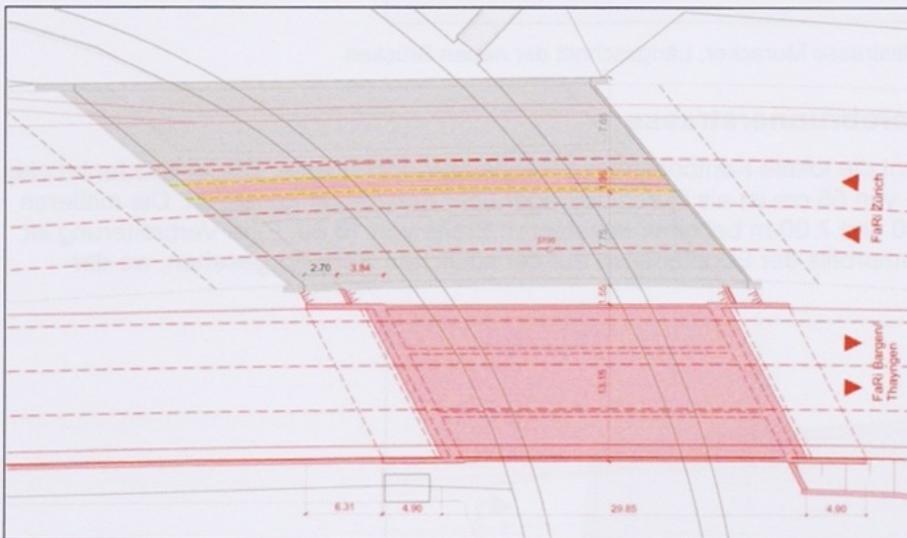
Unterführung Gemeindestrasse Muracker, Grundriss
